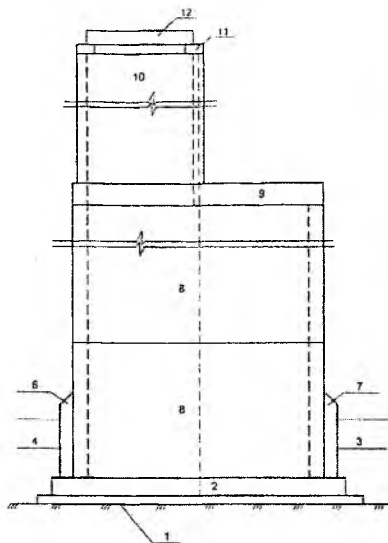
Конструкція круглого колодезя зі збірних залізобетонних елементів
